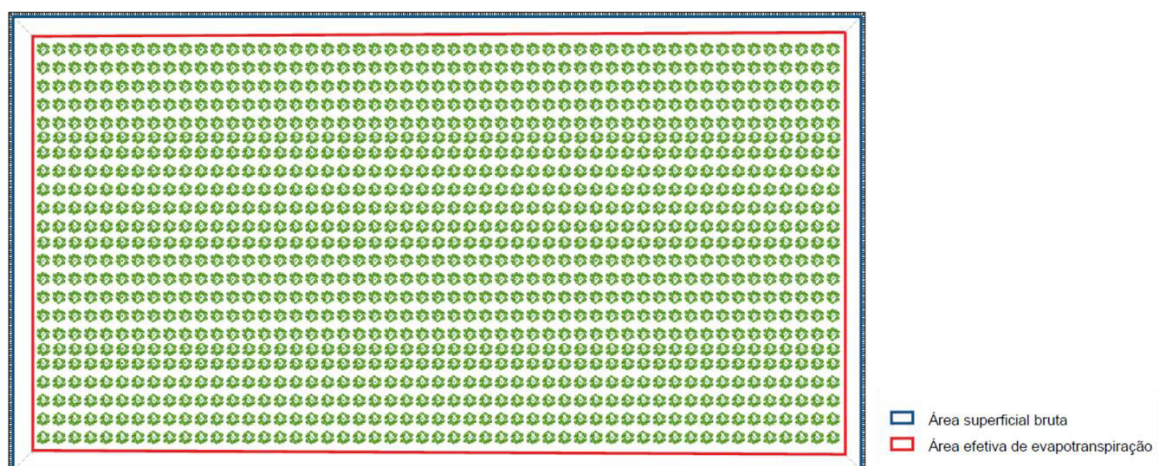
Planta da Unidade Piloto com identificação das áreas consideradas no dimensionamento.
